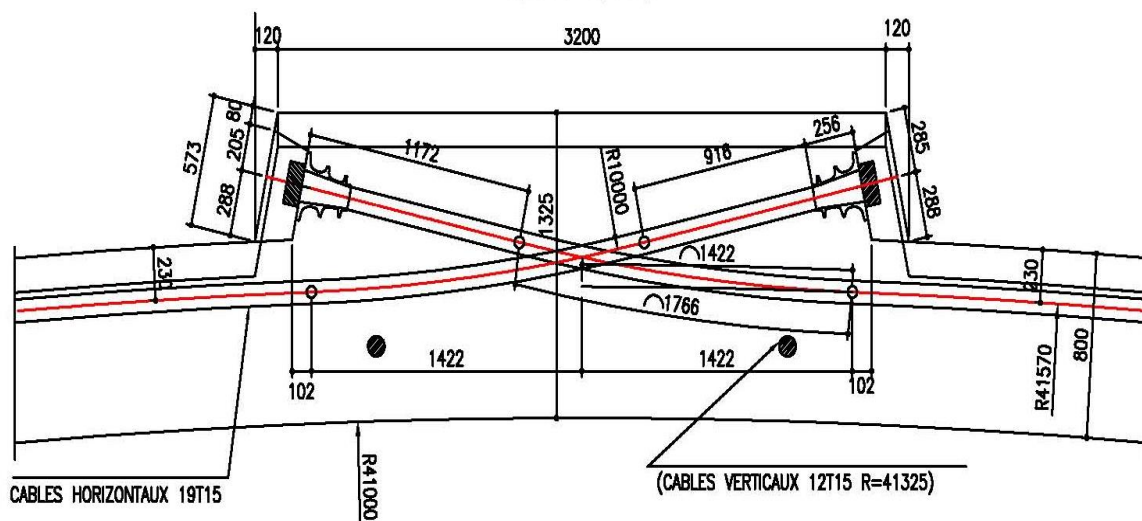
Coupe type sur bossage en zone courante de la jupe et au niveau de la poutre annulaire.
